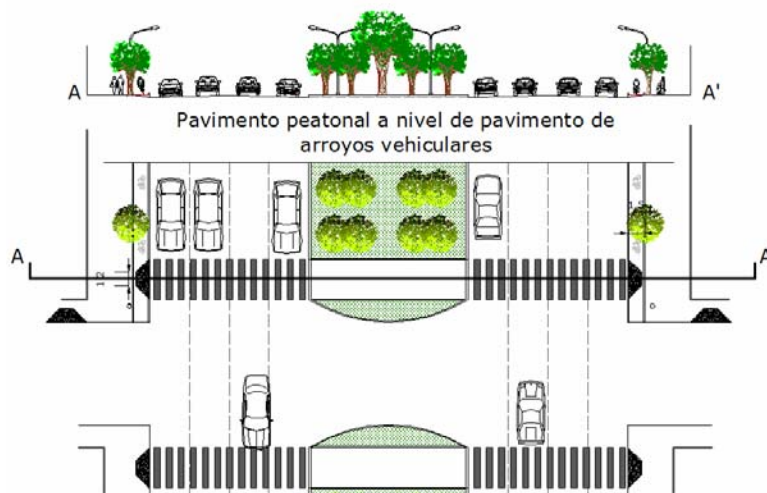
Sección de calle Tipo para el diseño de vialidades donde exista un camellón.
